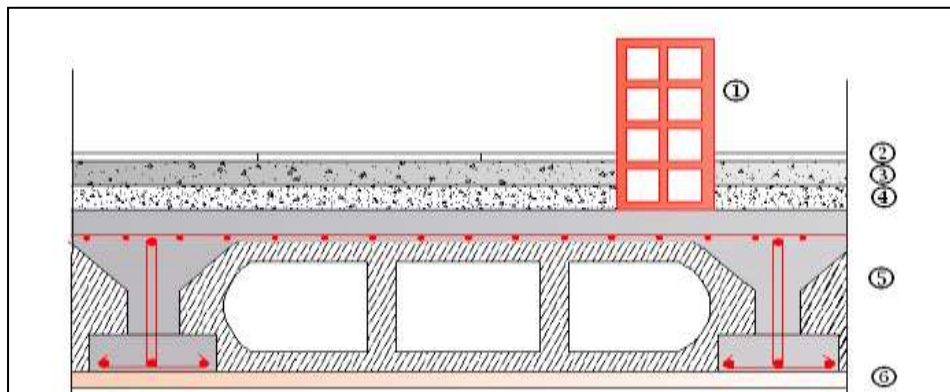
Coupe transversale au niveau de plancher étage courant.
